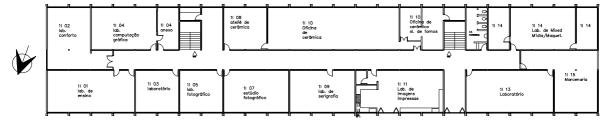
Planta baja del bloque de Arquitectura y Urbanismo – FAURB - UFU
